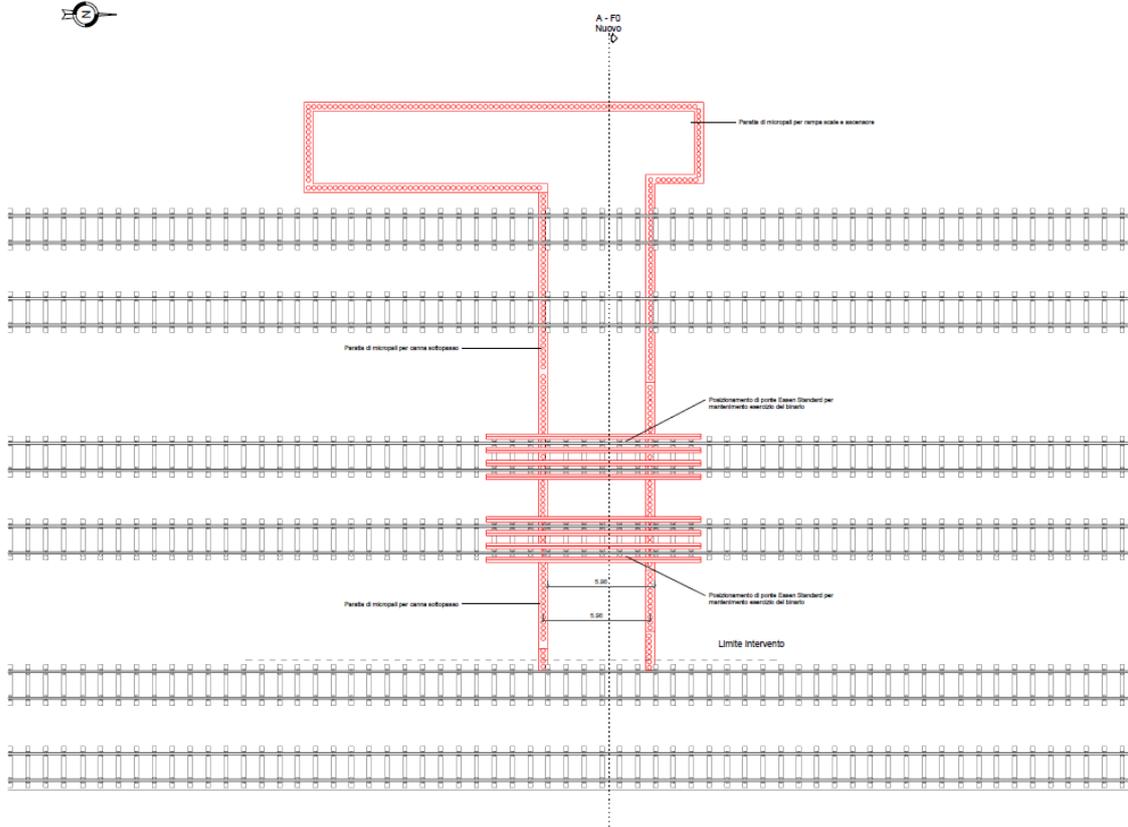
Nuovo sottopasso di stazione SL02 - Fase 0
